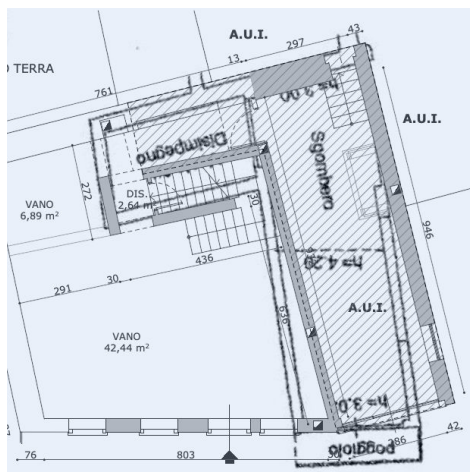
Sovrapposizione tra elaborato planimetrico e rilievo dell'immobile
